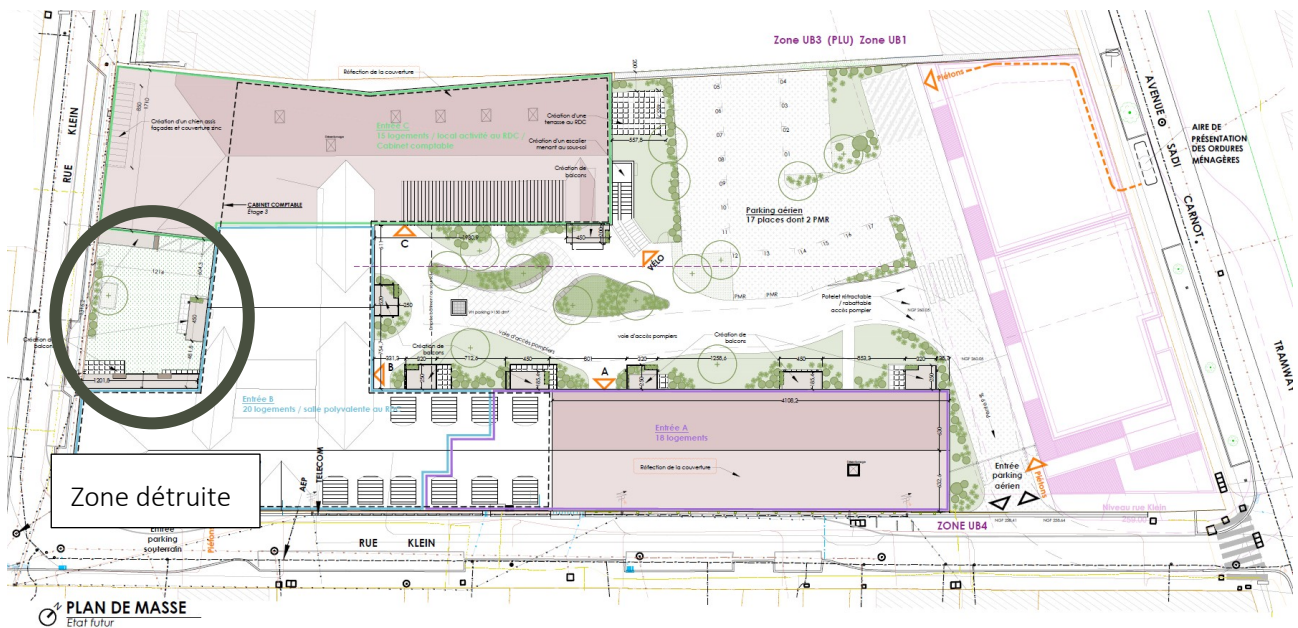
Plan final des travaux avec en noir la zone concernée par la démolition
